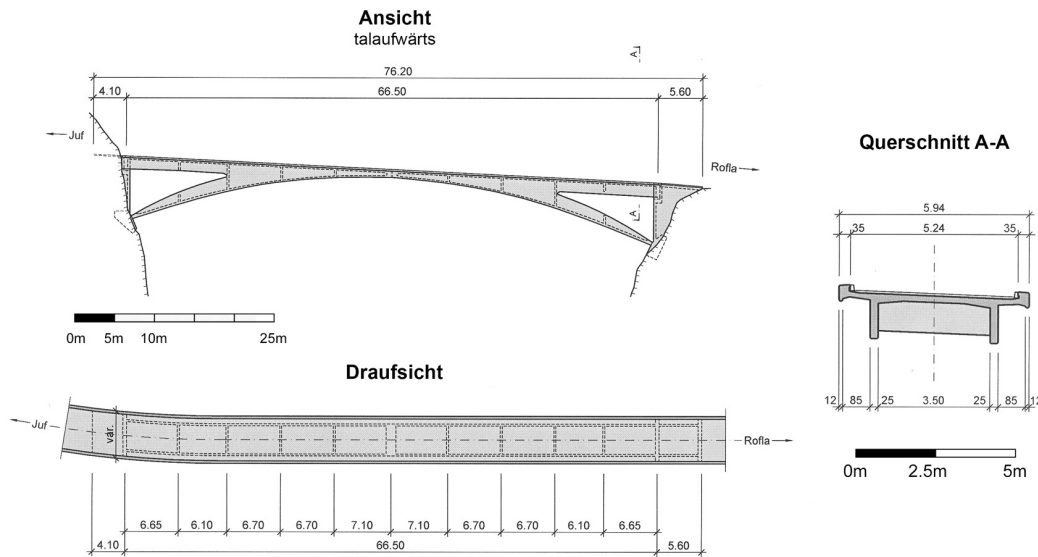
Letziwald-Brücke, Avers, GR - Ansicht, Grundriss und Schnitt
